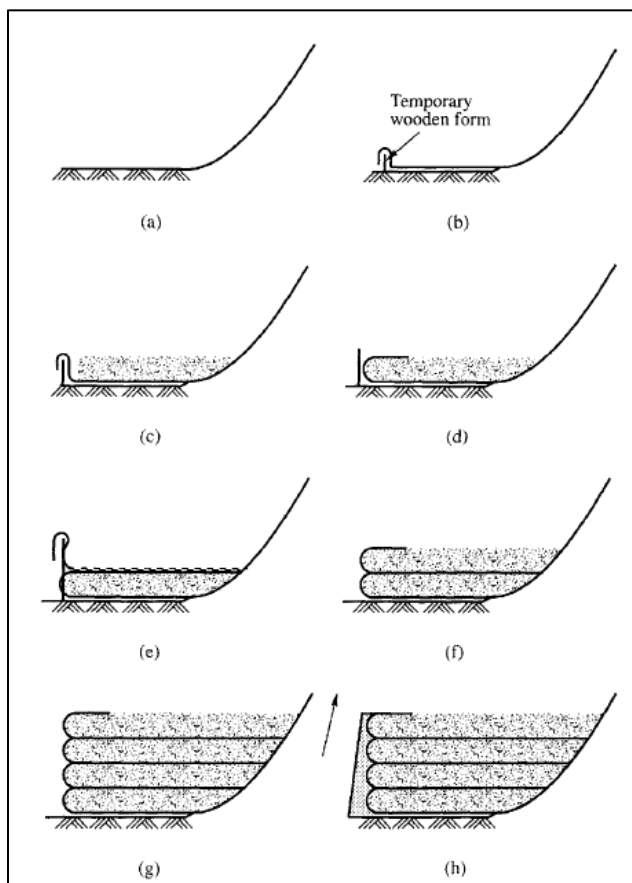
Procédures générales de construction pour l'utilisation de géotextiles dans la construction de murs de soutènement
